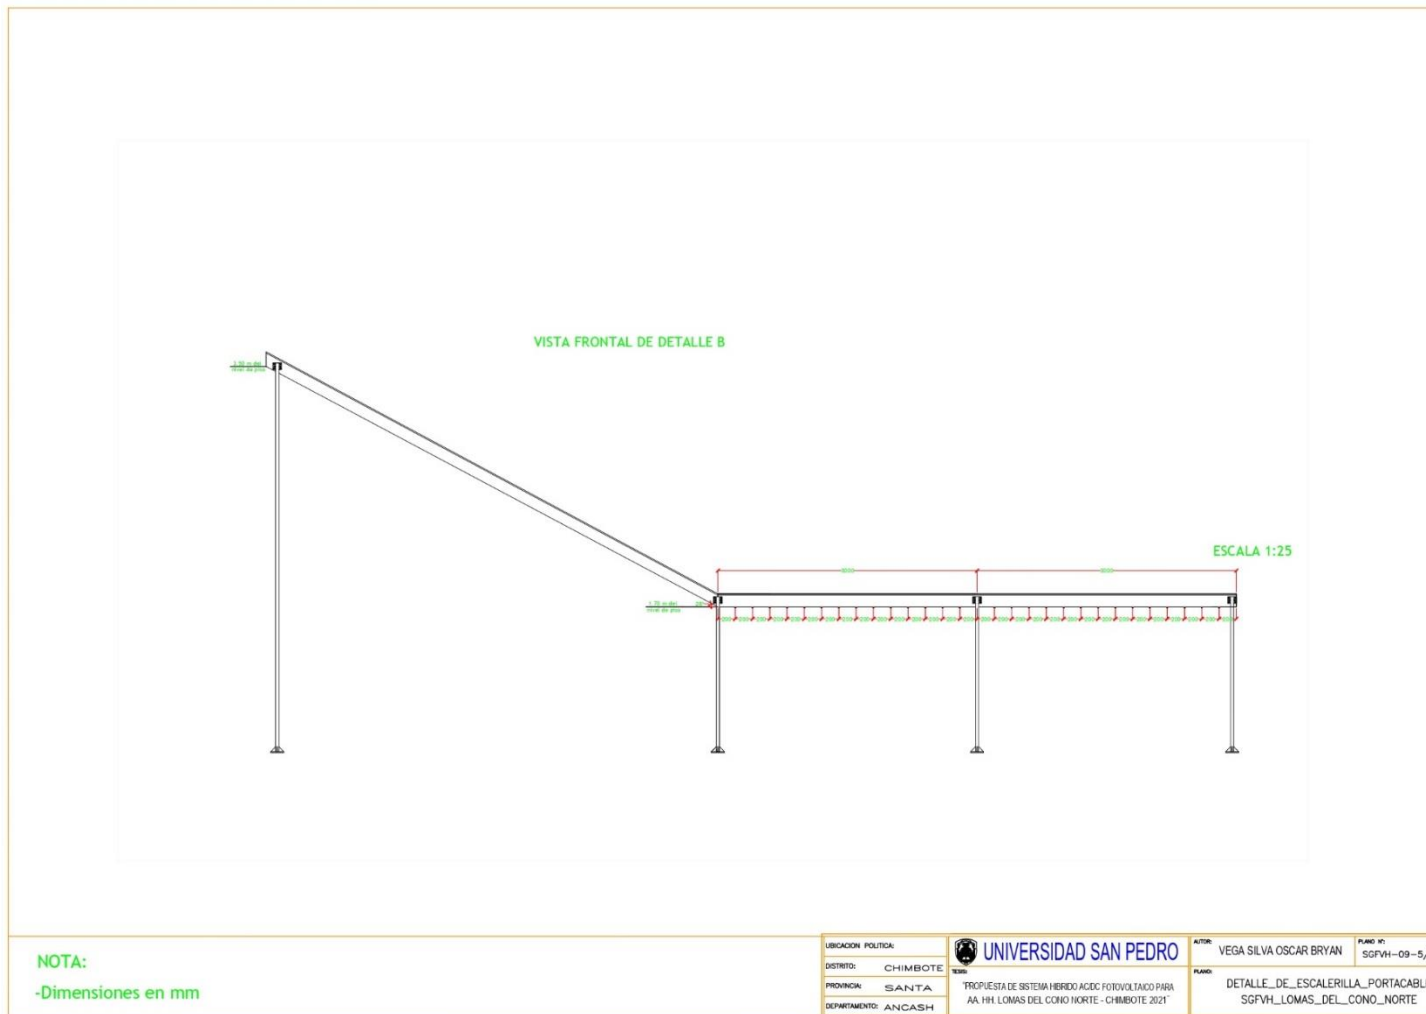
Detalle de Escalera Portacable Vista Frontal Detalle B_SGFVH.
